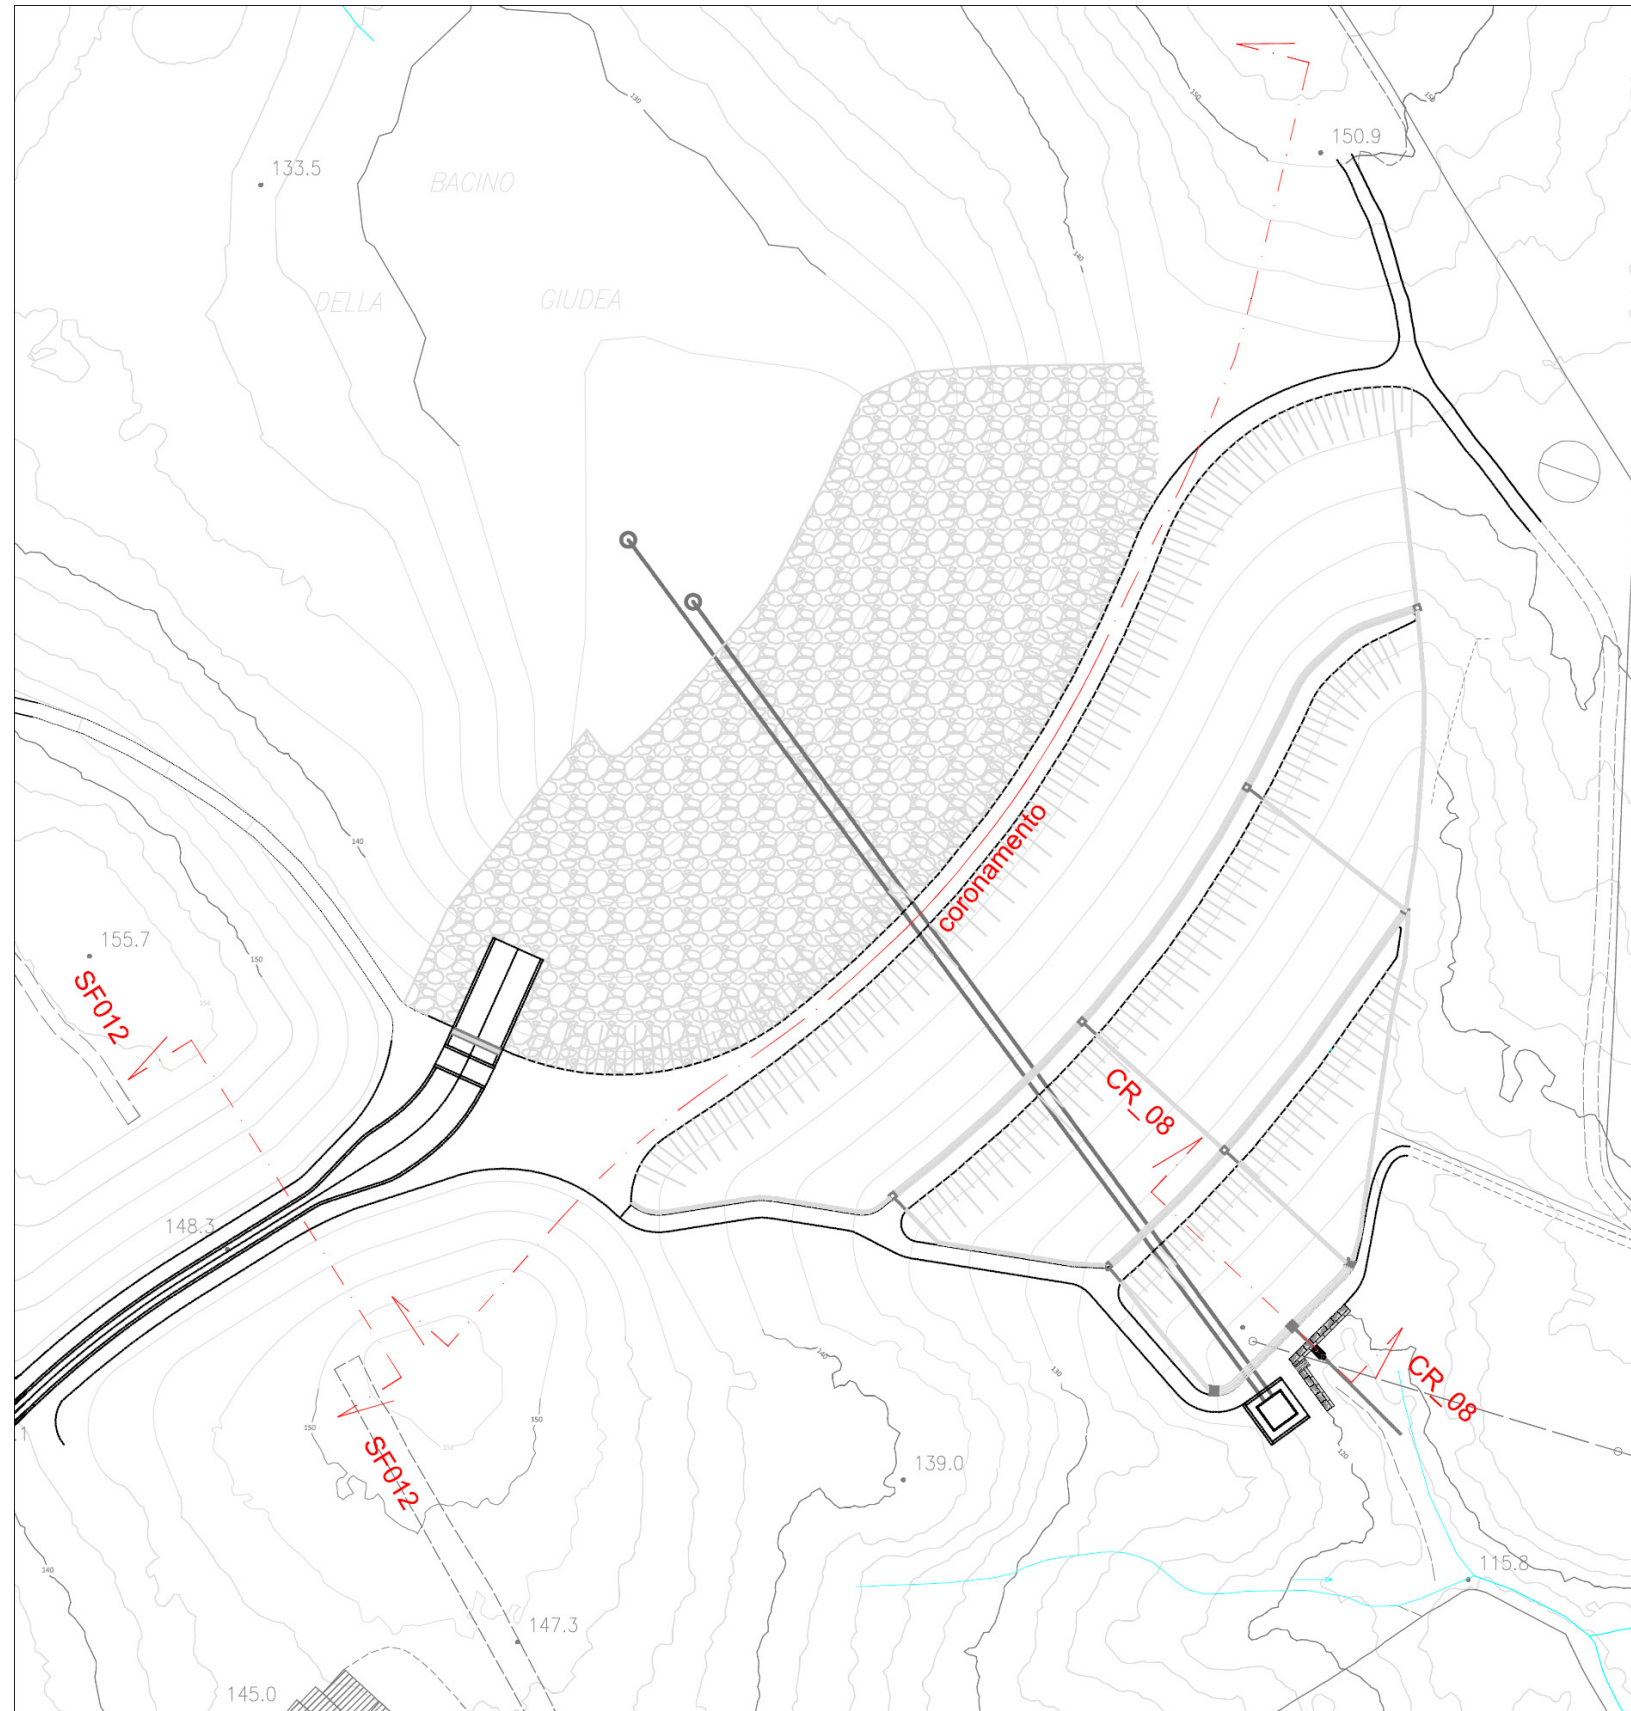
Planimetria sezioni di verifica (scala 1:1'000).
